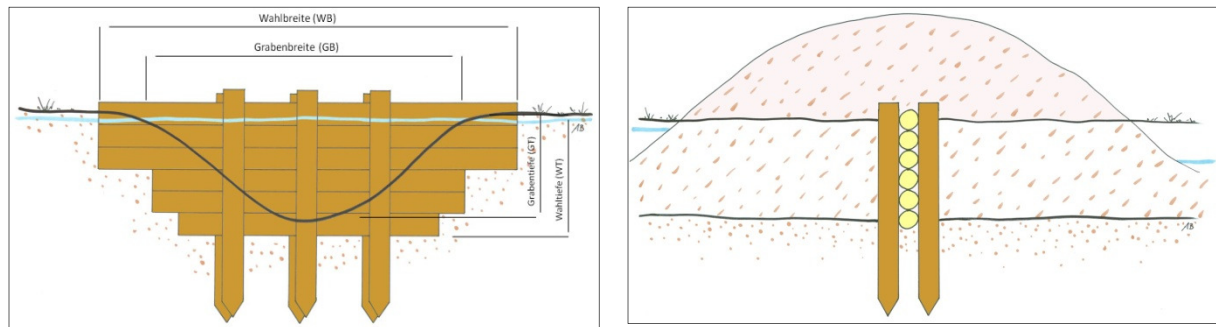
Stammarmierter Torfdamm (RQ), Frontalansicht und Schnitt
